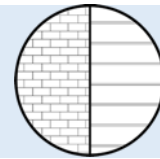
c : Exemple de doublage d'une façade existante avec une double enveloppe partiellement accessible, ventilée ou non
